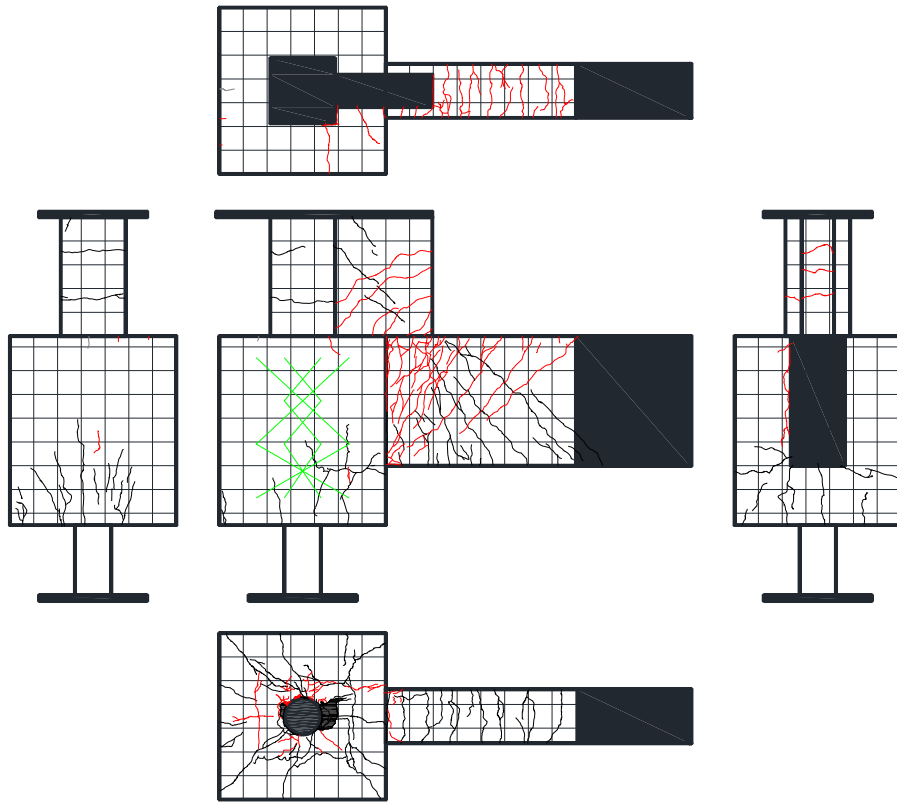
試験体 DR-2 ひび割れ状況 (9Cycle)
